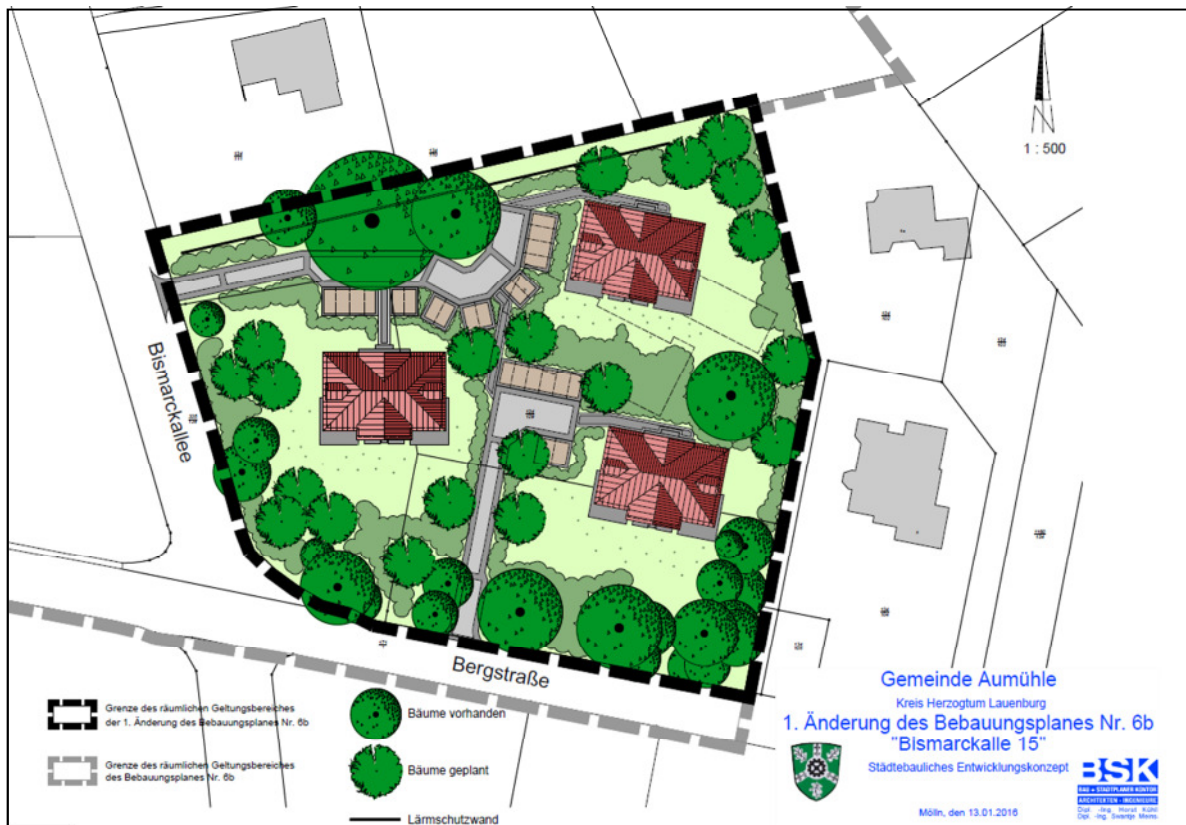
Städtebauliches Konzept zum B-Plan Nr. 6b (1. Änderung) der Gemeinde Aumühle (erstellt durch BSK, Stand: 13.1.2016)
